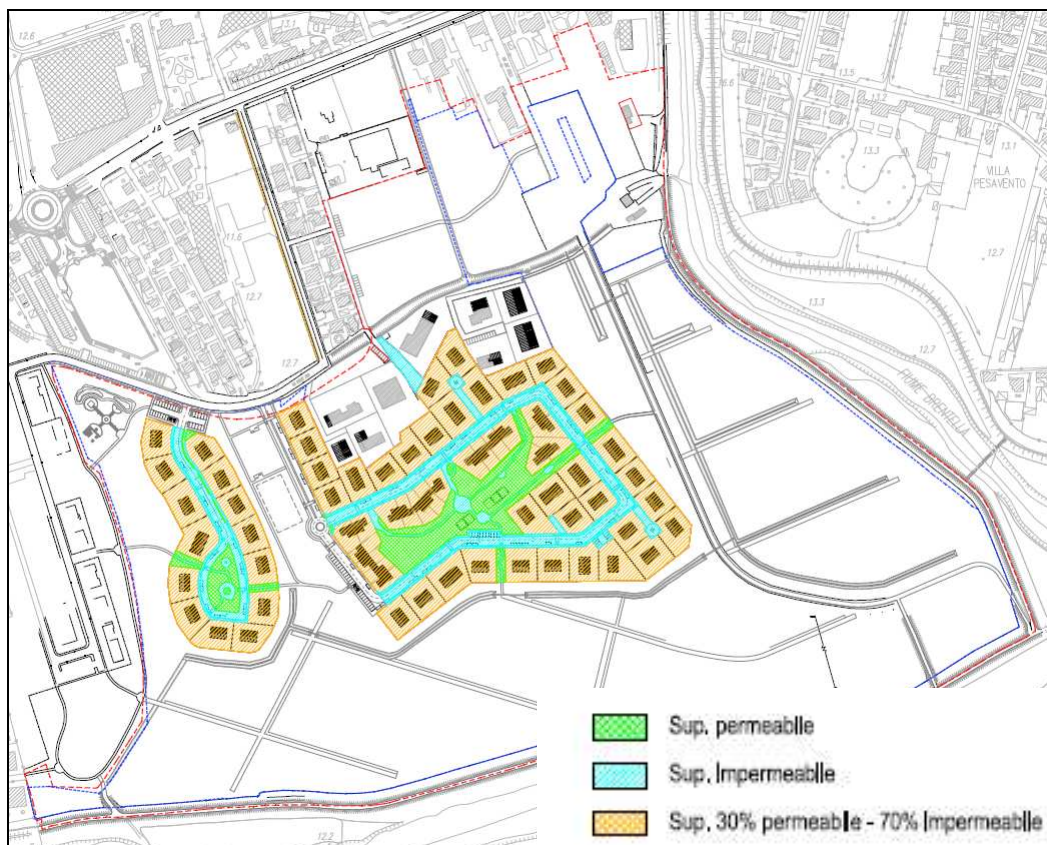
Planimetria uso del suolo del Piano di Lottizzazione Brentella allo stato di progetto.
